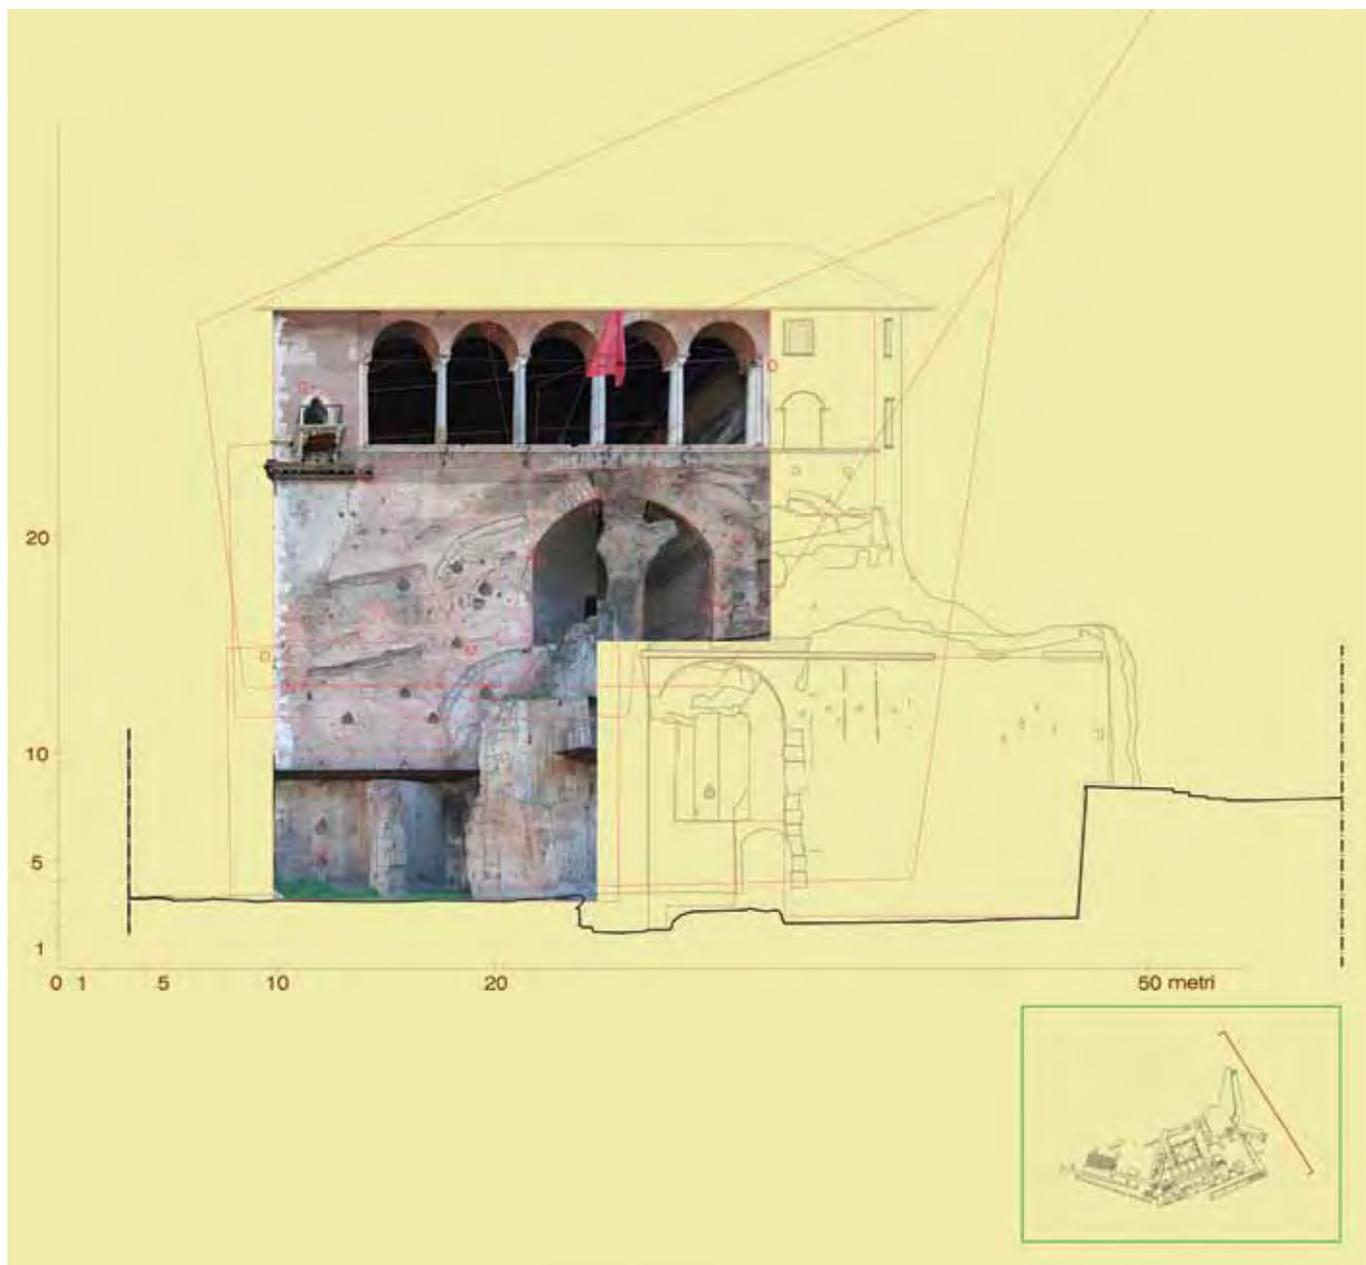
Il montaggio delle foto raddrizzate.
